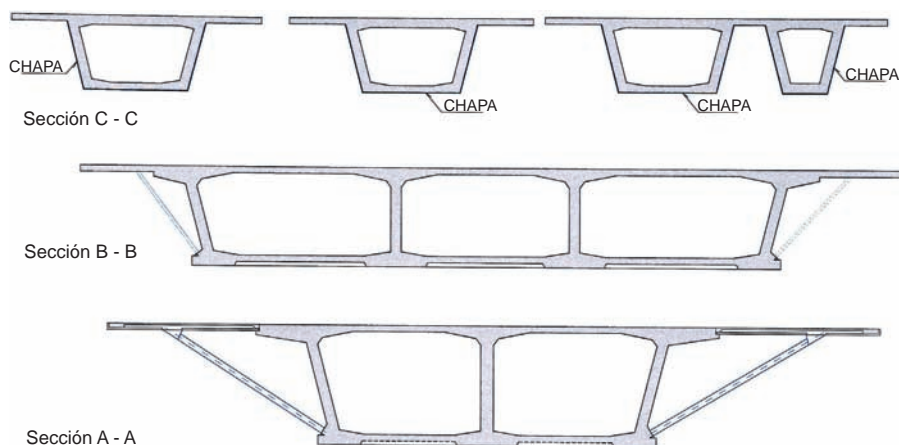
Viaducto zona de transición. Secciones fundamentales.
